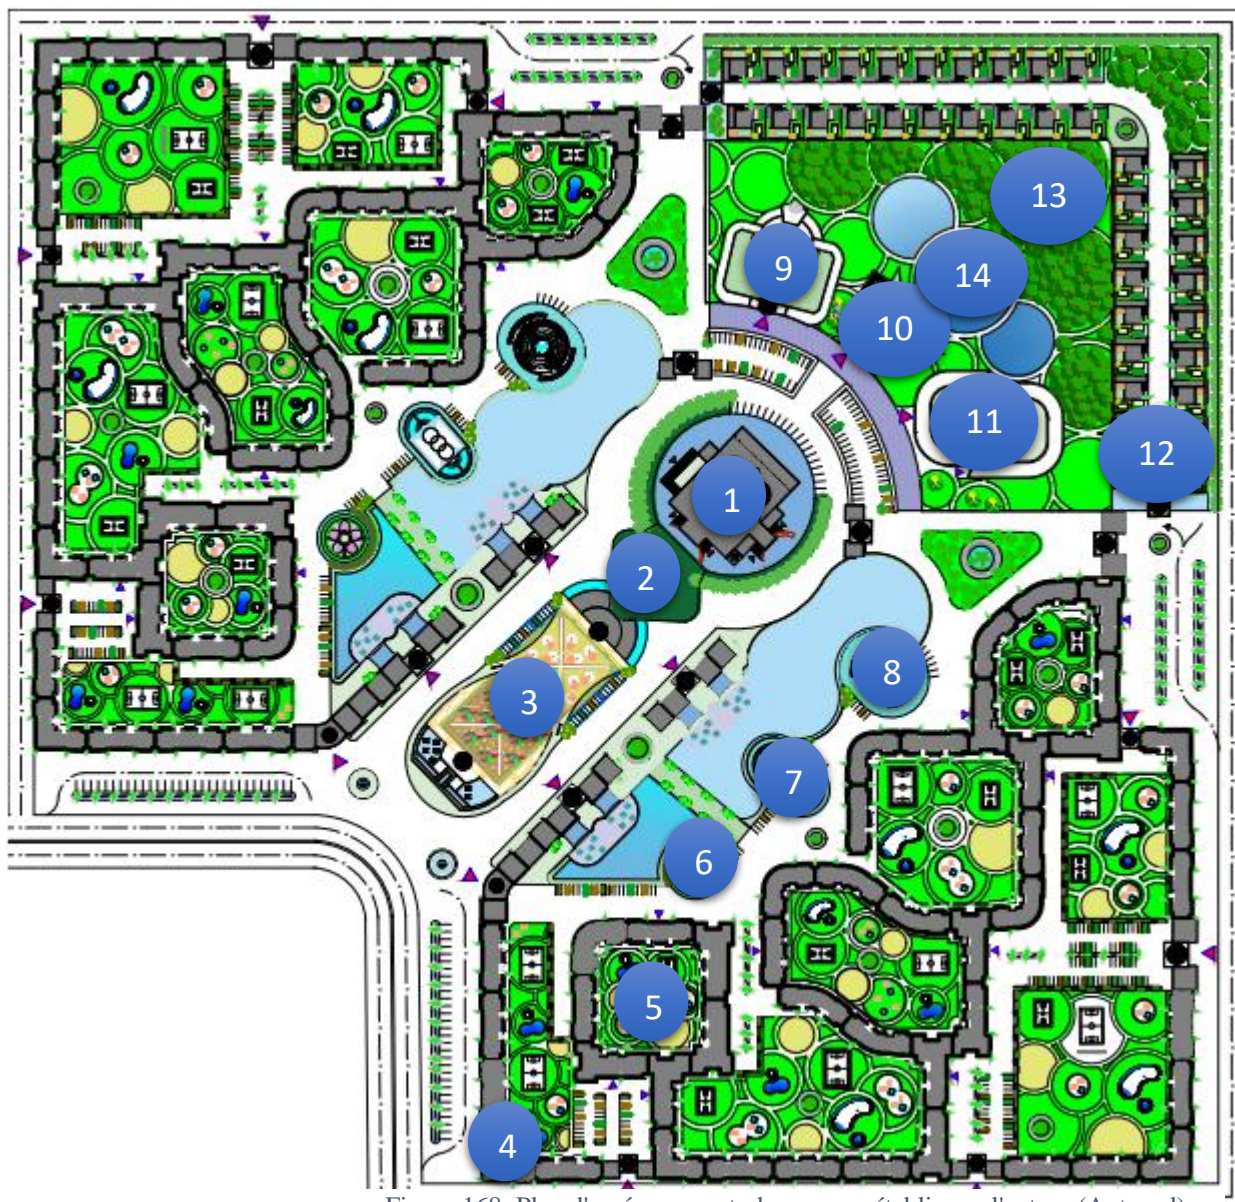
Plan d'aménagement : la source : établie par l'auteur (Autocad)
